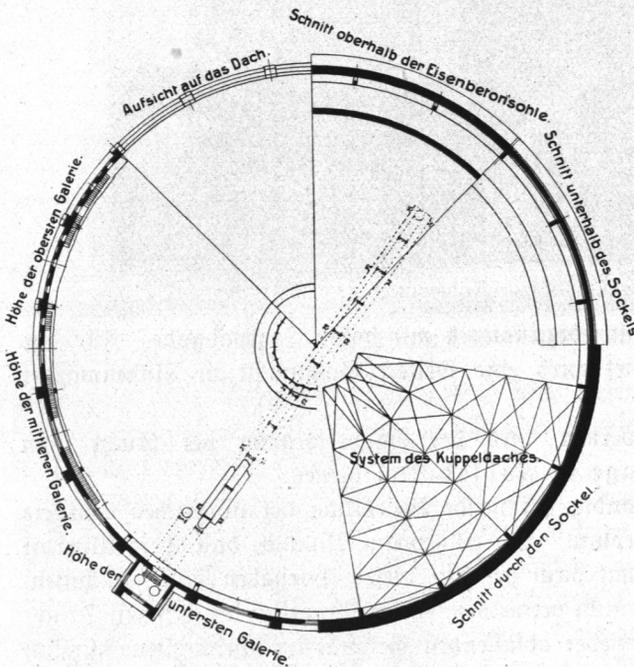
Gasbehälter Fuhsbüttel, Grundriß.
